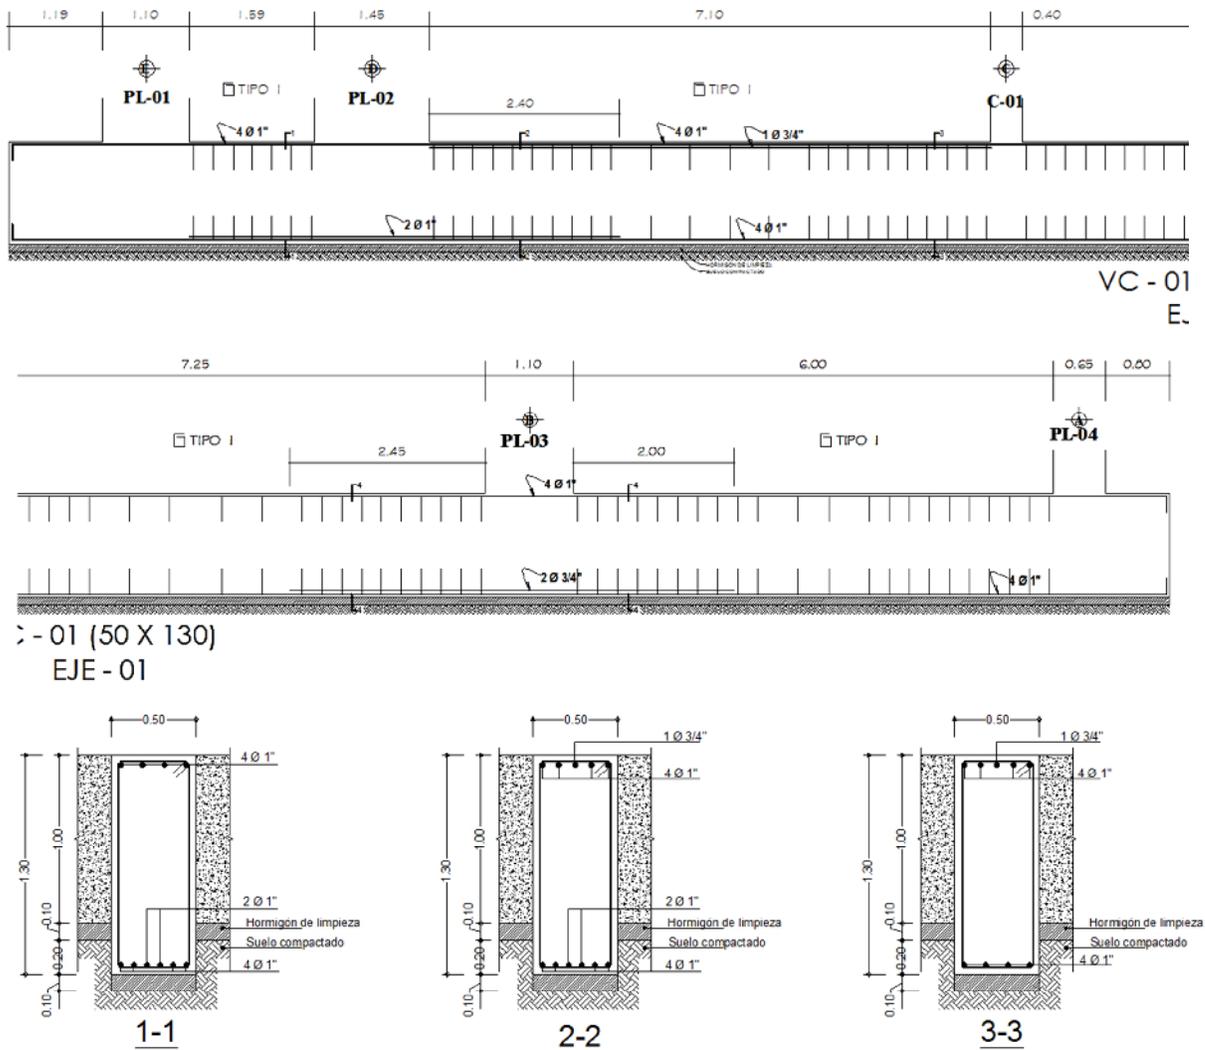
Diseño Final de Tramo Seleccionado de la Viga de Cimentación VC-01.
